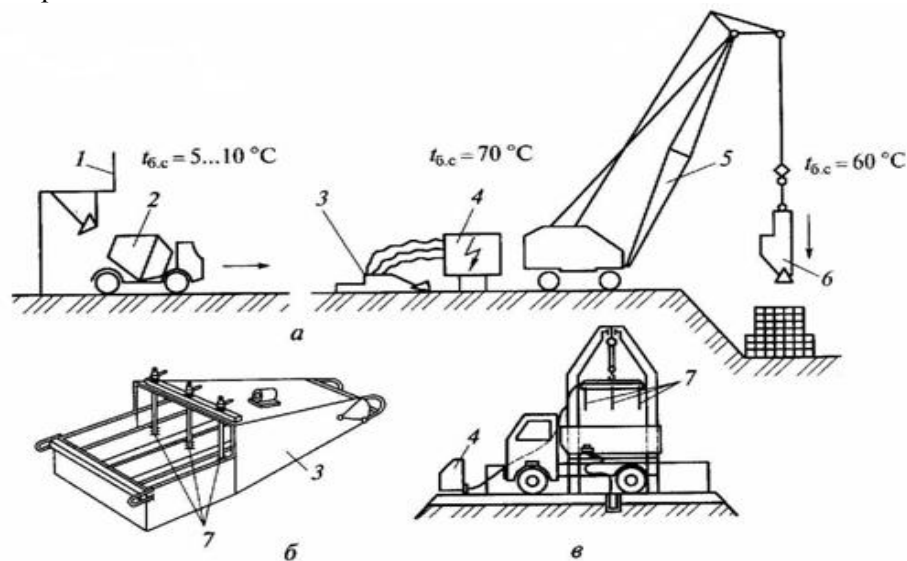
Схема бетонирования конструкций с предварительным разогревом бетона:
